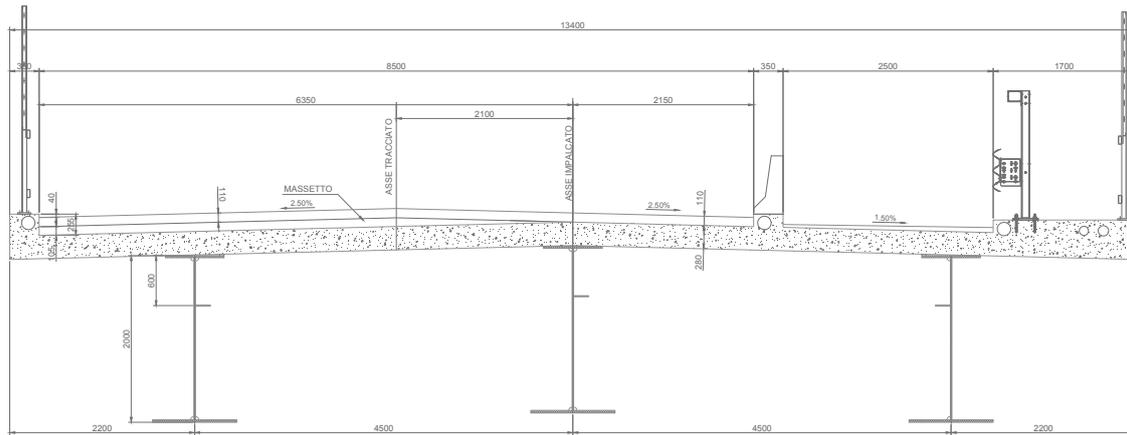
Sezione trasversale impalcato Cavalcavia via Venezia
